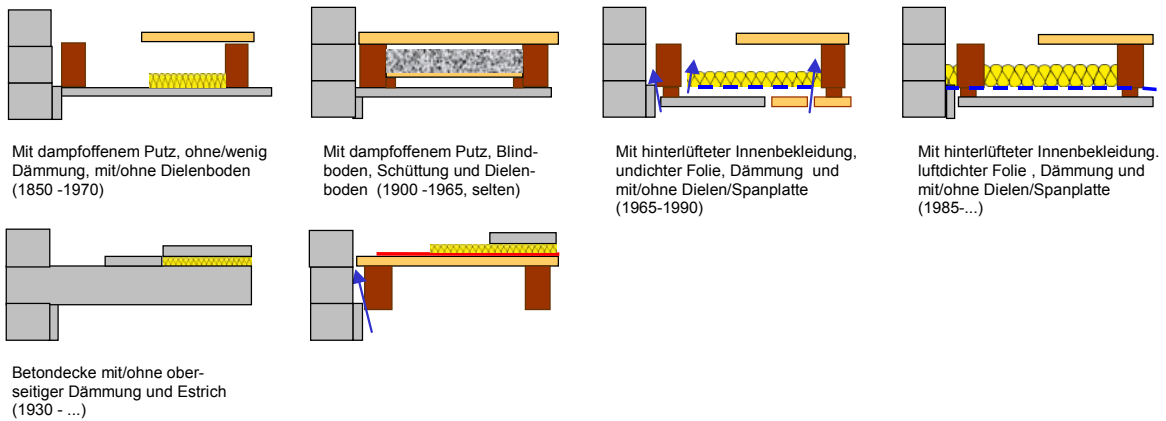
Kehlbalkendecken, Bauarten
